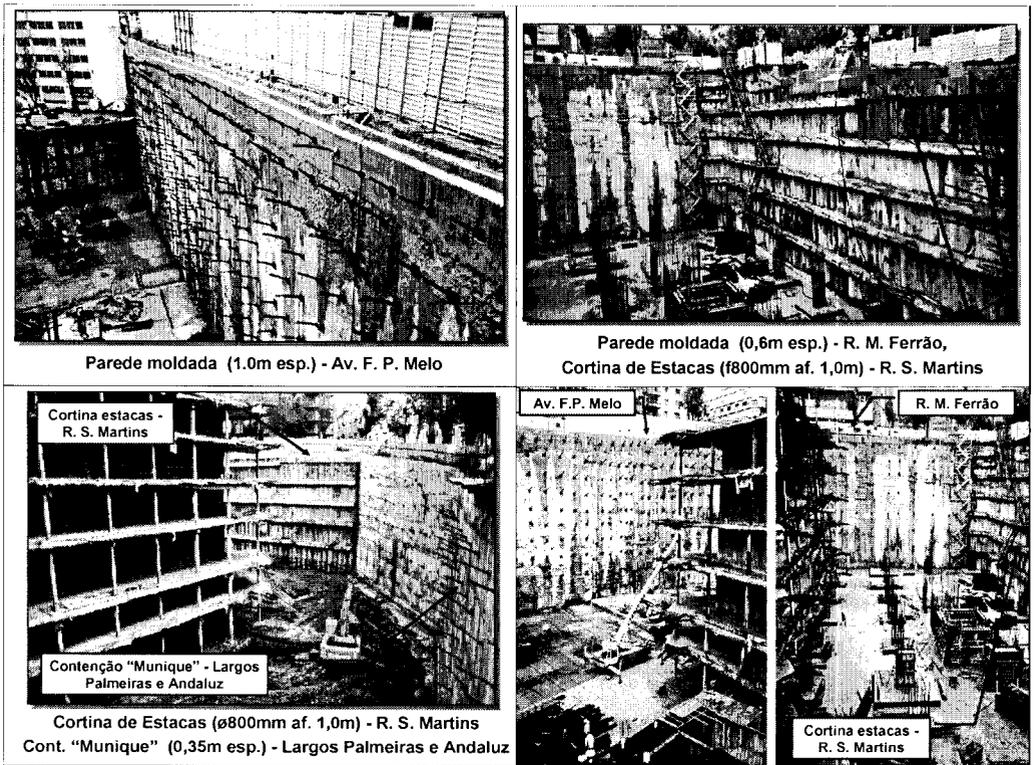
Vistas da contenção periférica na fase final da escavação.
